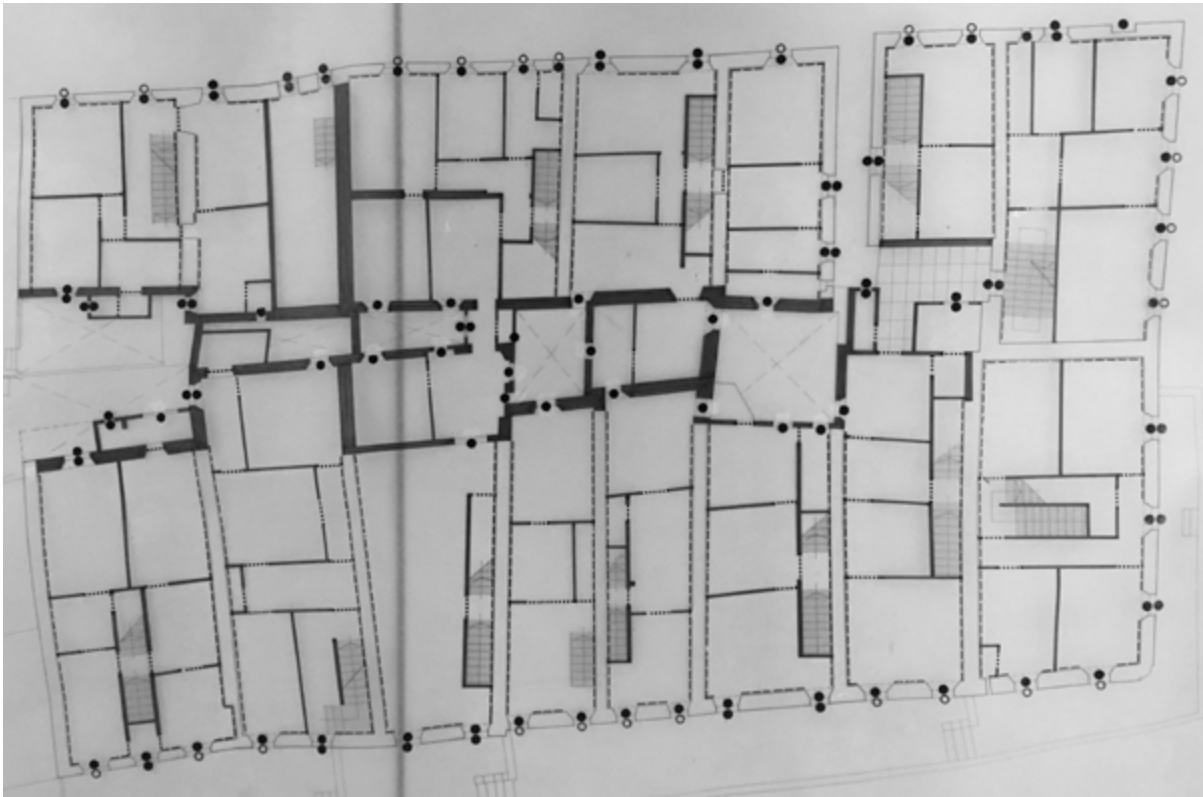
Ancona, Rione di Capodimonte, progetto di risanamento e ristrutturazione del centro storico, pianta del piano terra, 1976, nella quale si indicano le murature da demolire (campiture nere), gli intonaci da spicconare (linea tratteggiata), le porte da demolire (linea puntinata), i serramenti da rimuovere (cerchio nero) e quelli da recuperare (cerchio). APIUAV, Trincanato 3, Attività professionale, 1, 062, 5.
